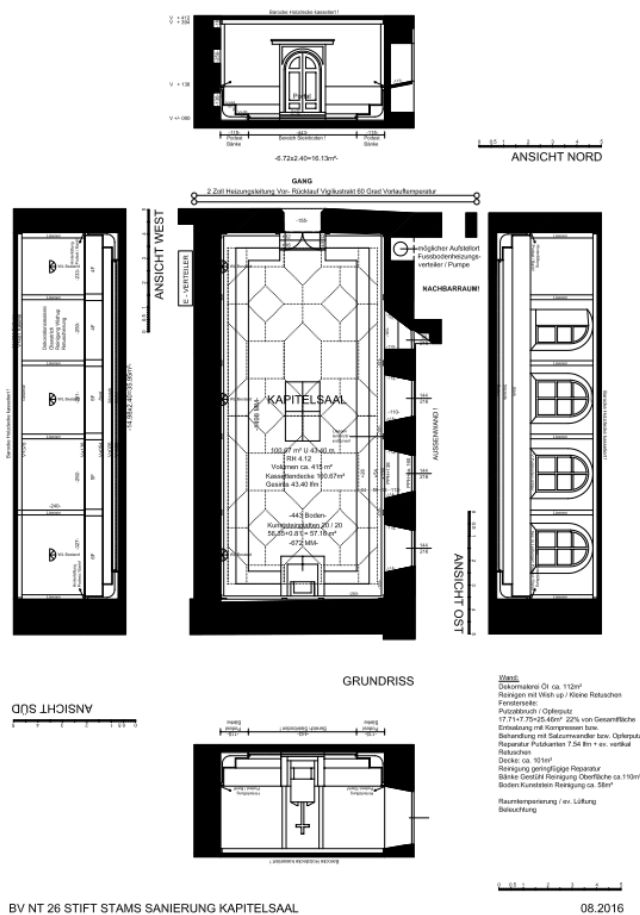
Stift Stams, Grundriss des barocken Kapitelsaals
